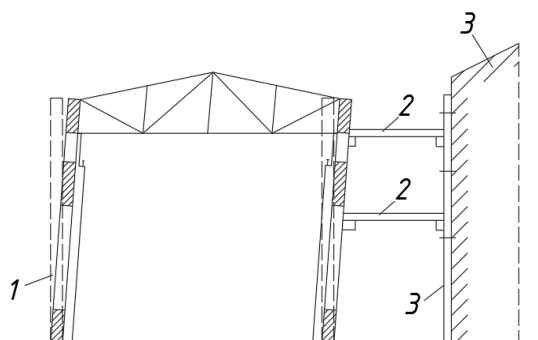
Кріплення нахилених будівель до стін стійких будівель:
